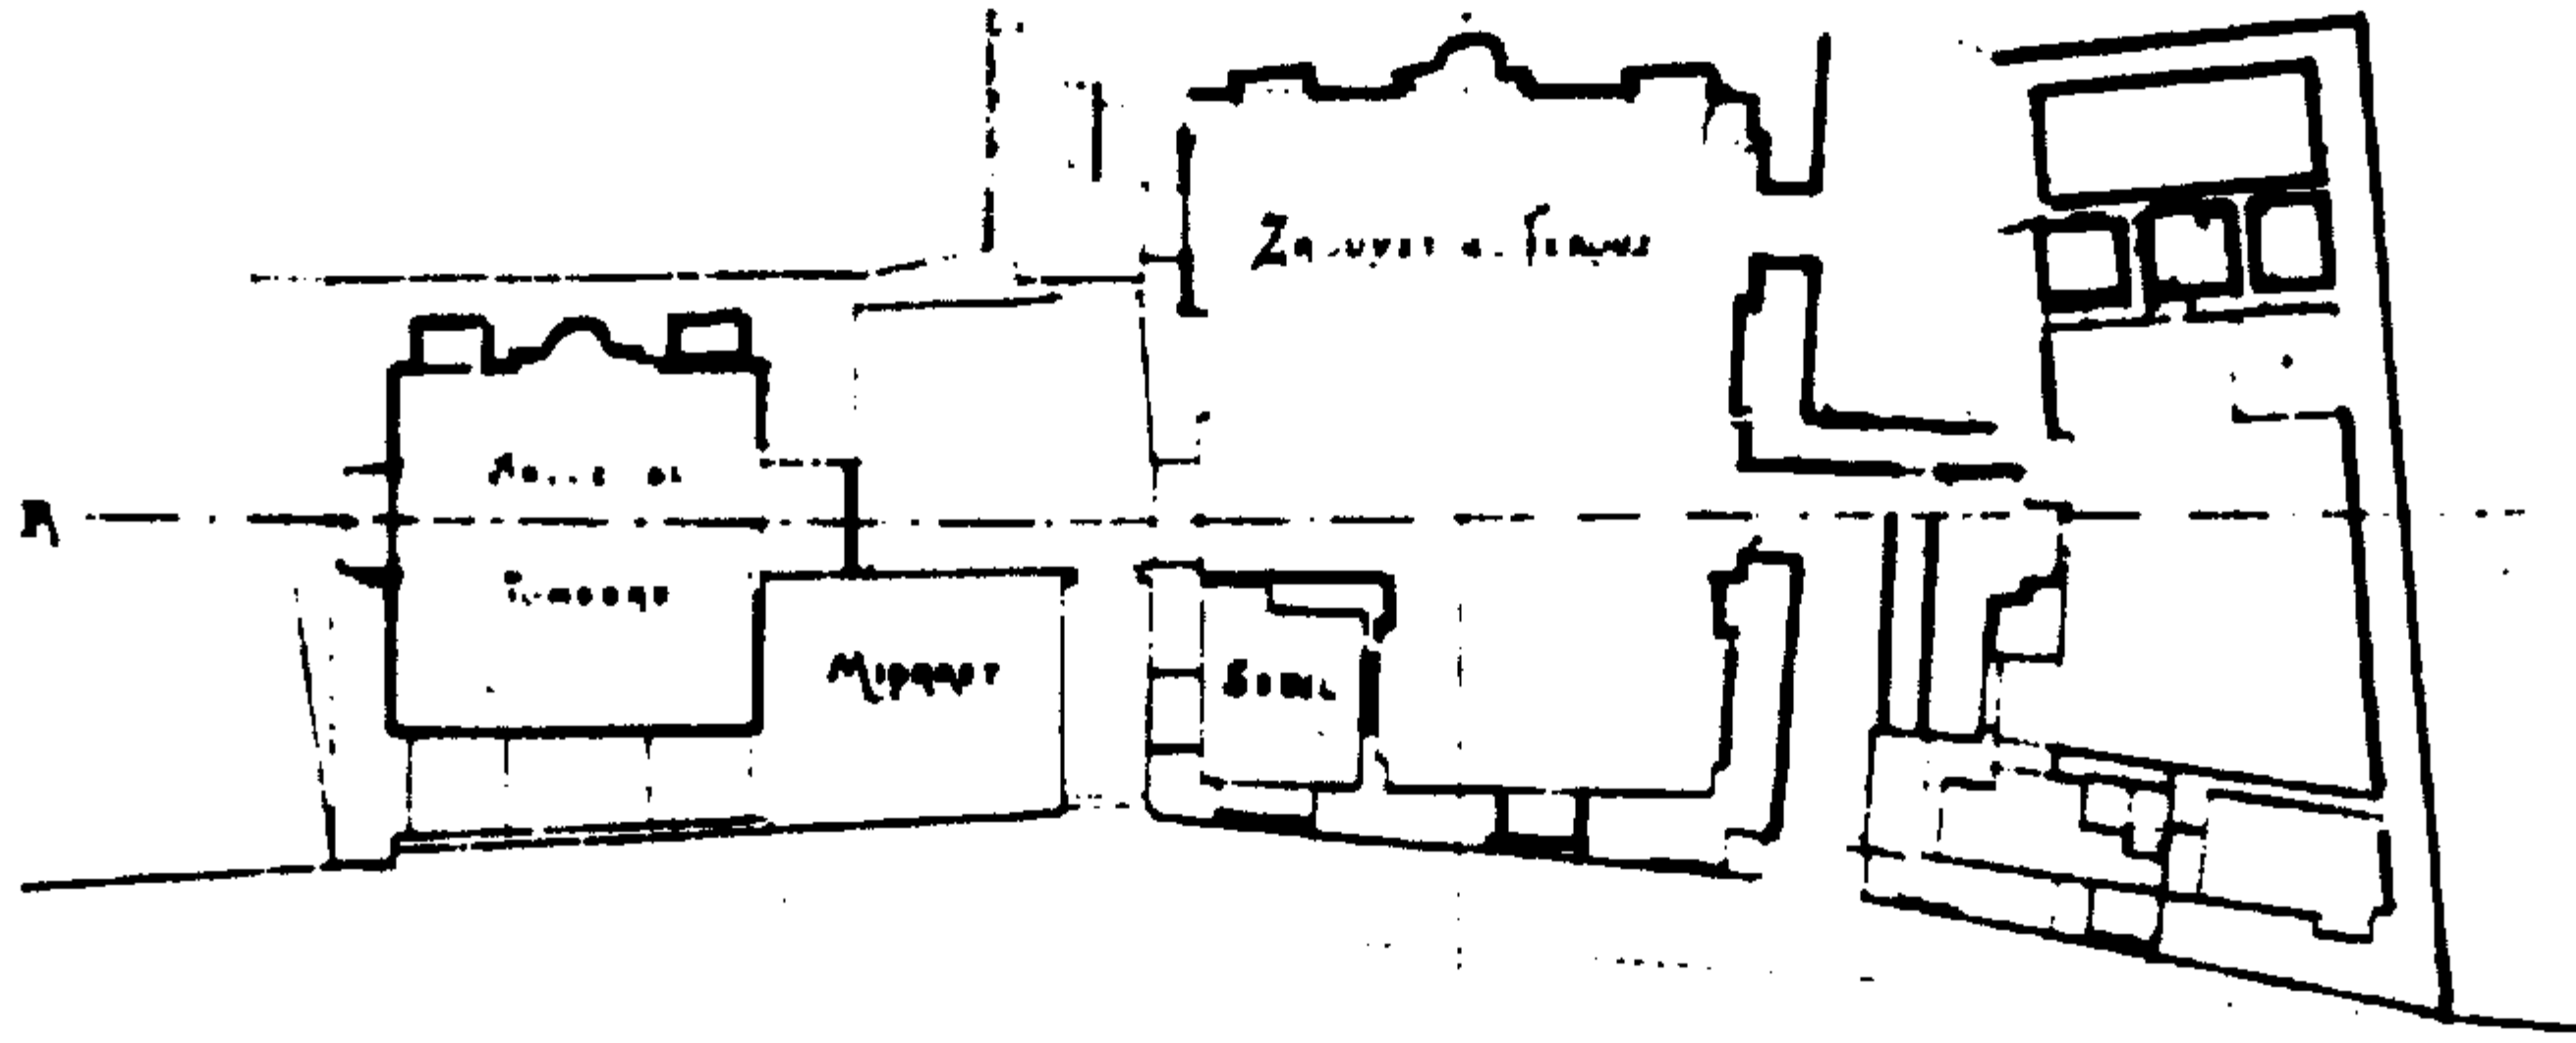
مسقط أفقي للمدرسة النورية بدمشق.
